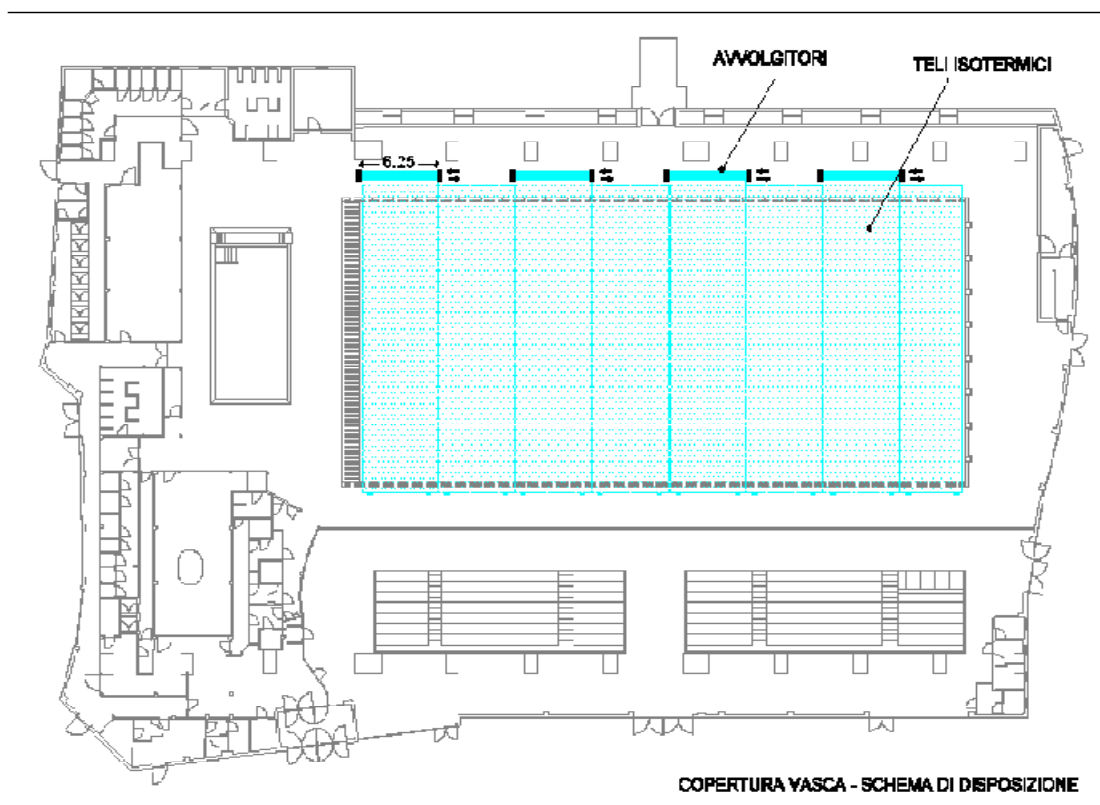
planimetria con schema di disposizione teli isotermici
